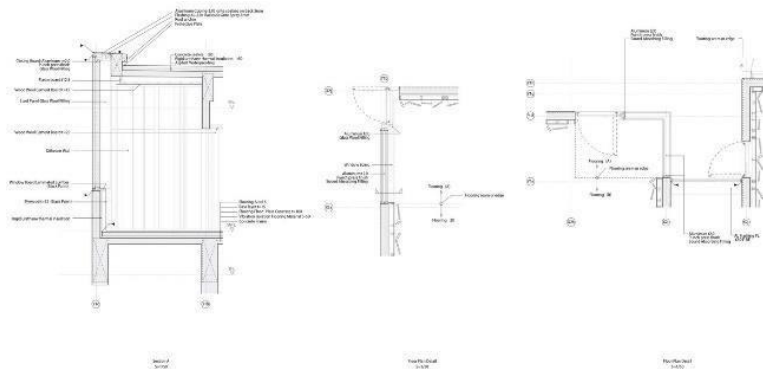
Detalles Constructivos y Materiales. Archdaily 2014
